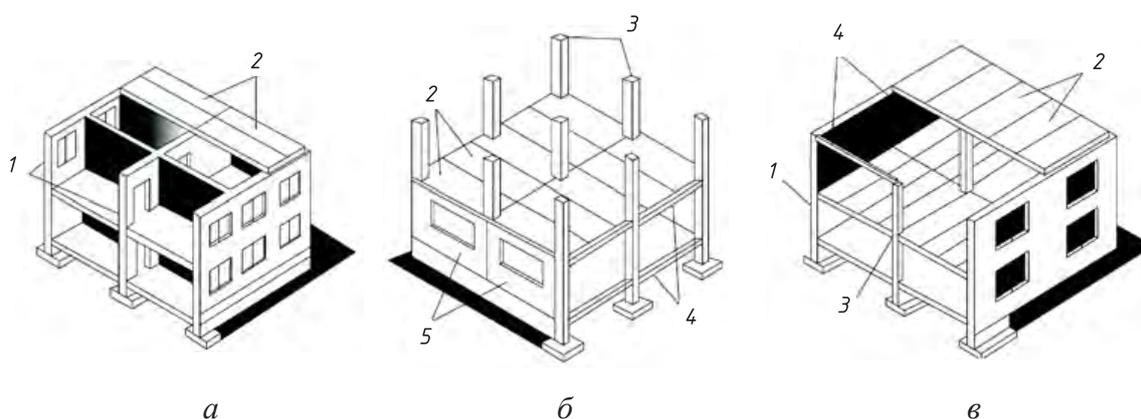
Конструктивные типы гражданских зданий: *а* — бескаркасный; *б* — каркасный; *в* — с неполным каркасом: 1 — несущие стены; 2 — междуэтажные перекрытия; 3 — колонны; 4 — ригели; 5 — самонесущие стены
